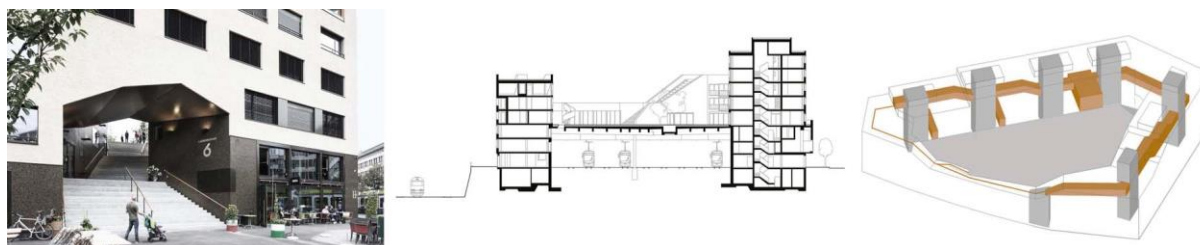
Escalera de acceso a la plaza, sección transversal y calle interior. Foto: Martin Stollenwerk, planimetría: Müller Sigrist.
